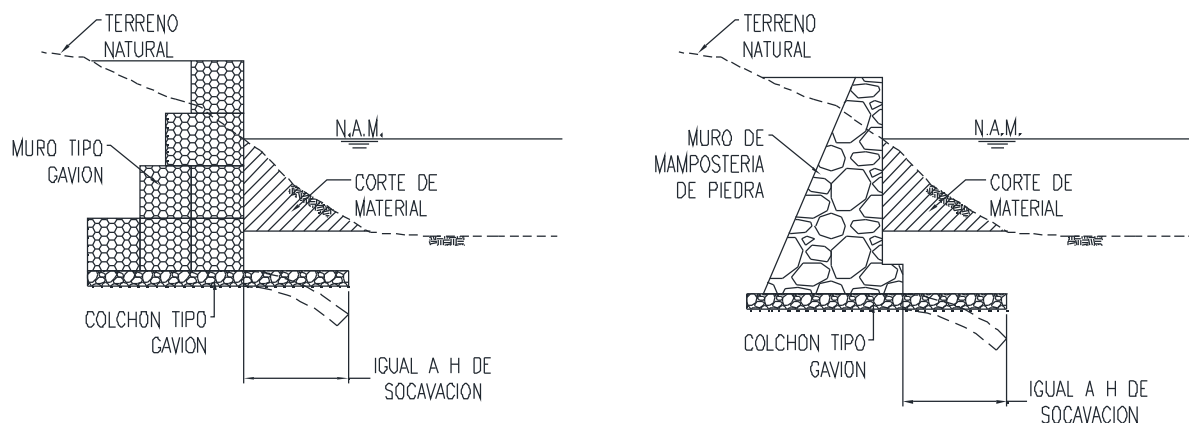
Tipos de protecciones para muros de márgenes con colchón tipo "Reno" (tipo gavión). (SPOP, 2014)
